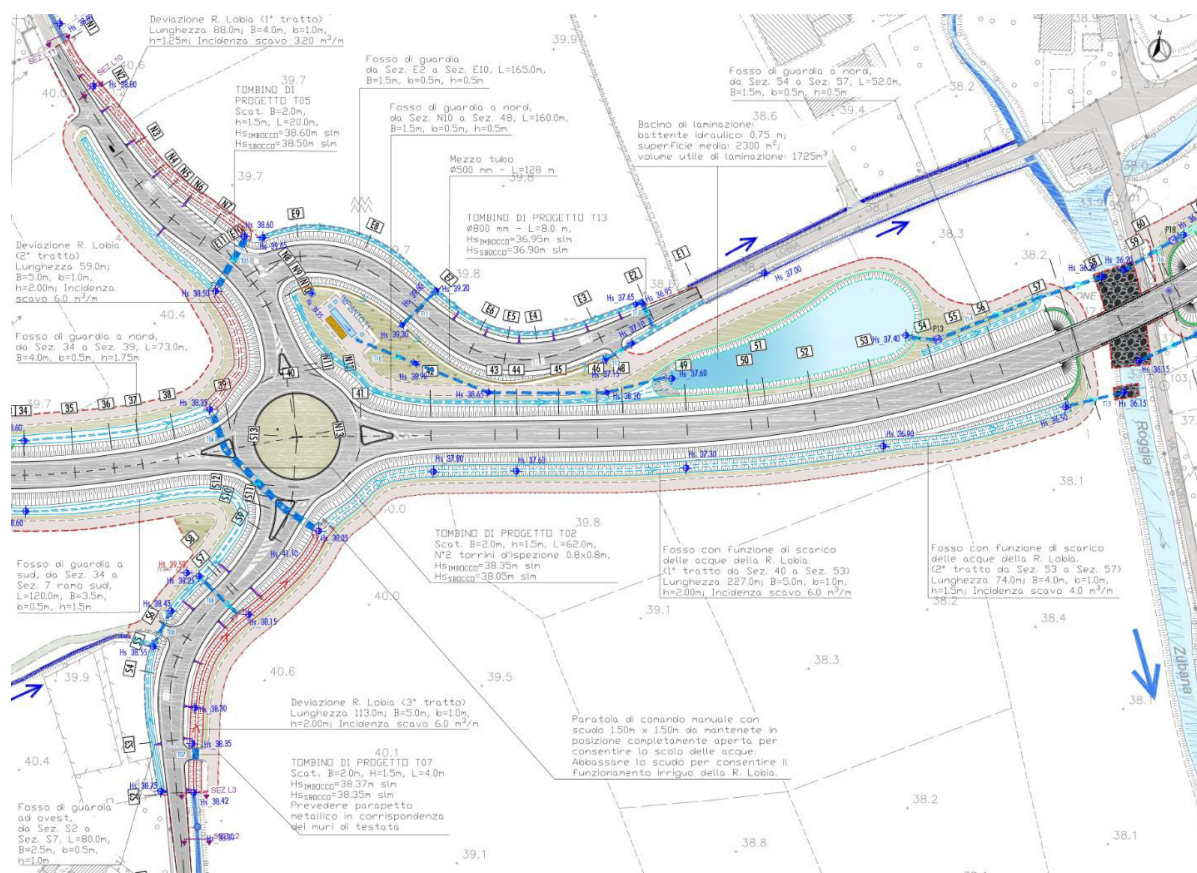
PLANIMETRIA DI PROGETTO DELLA RISOLUZIONE DELLA ROGGIA DELLA LOBIA
